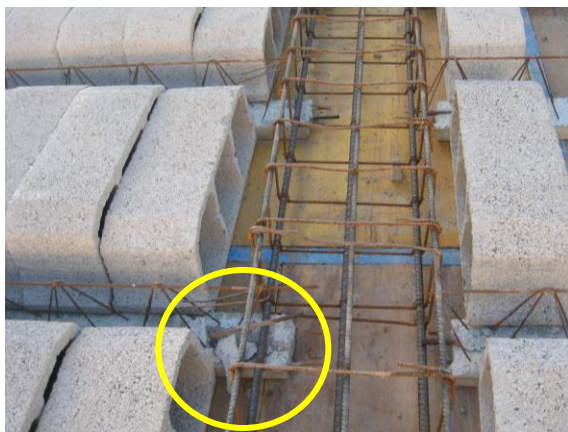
Montaje de viguetas bajo el armado inferior de la viga. INCORRECTO
